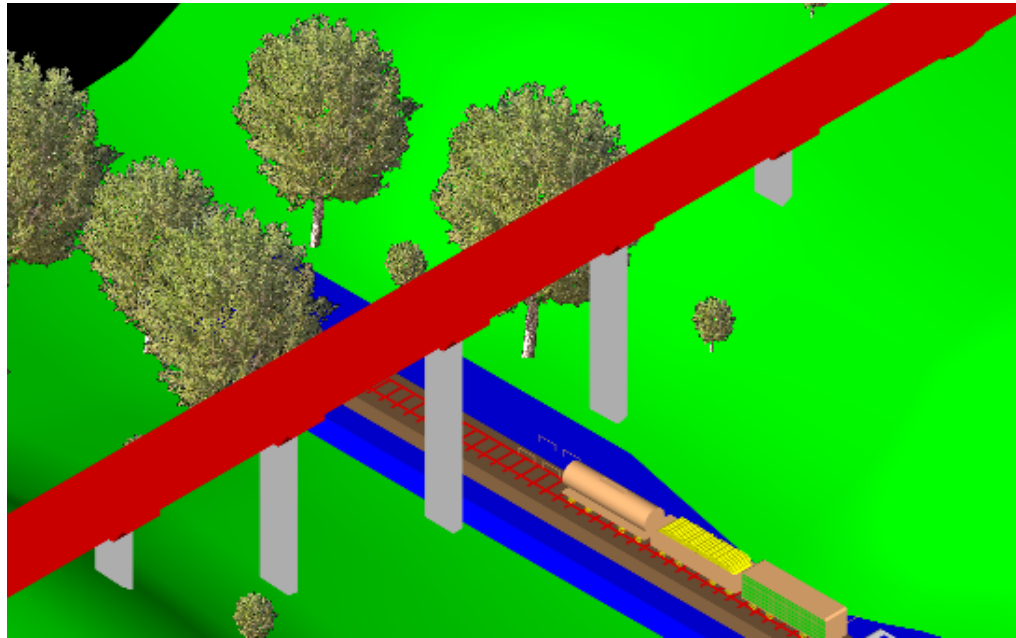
Imagen de losas apoyadas en las columnas, con el parapeto.
